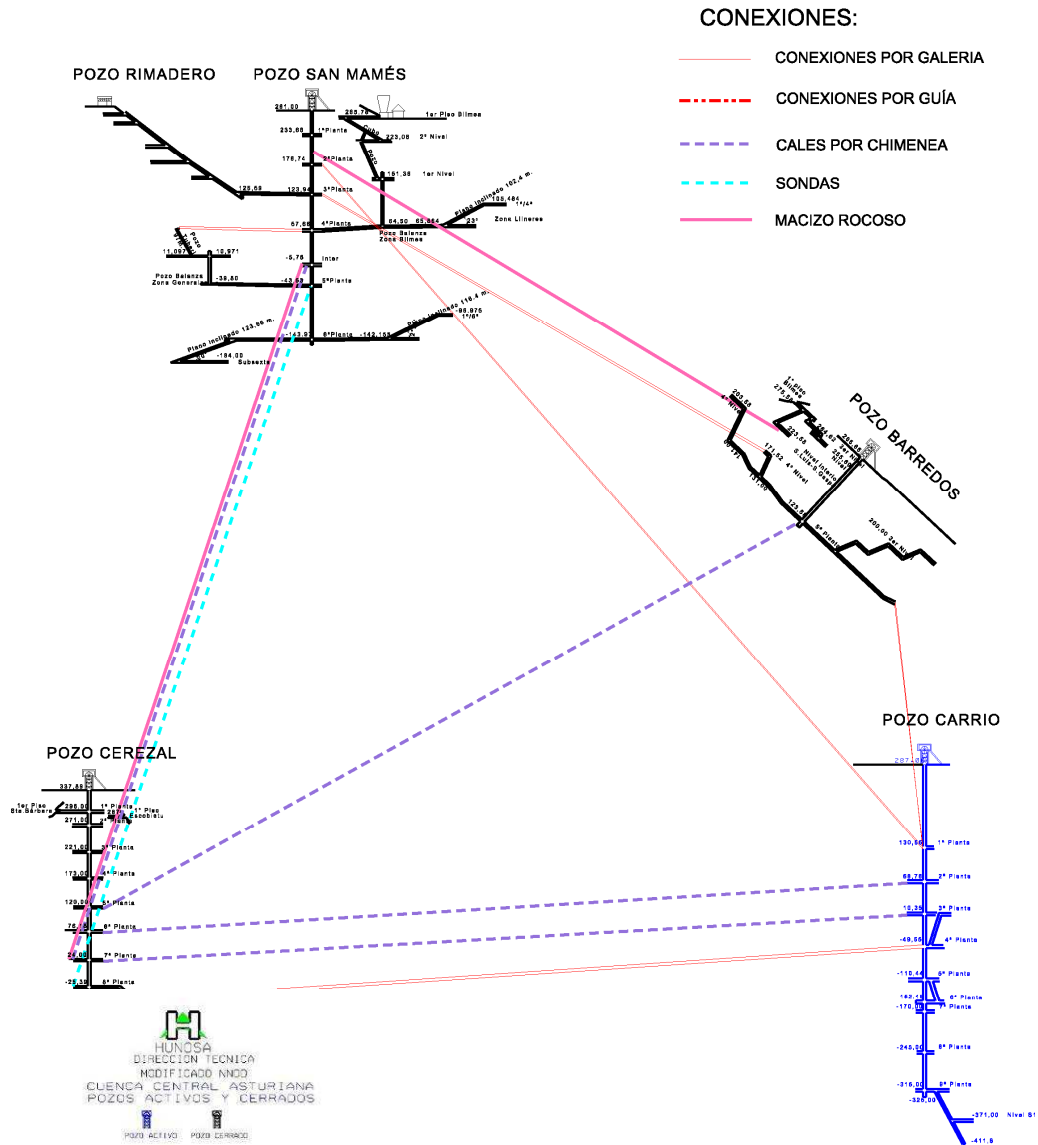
Plano de conexiones entre los principales pozos de la Zona Carrio.
